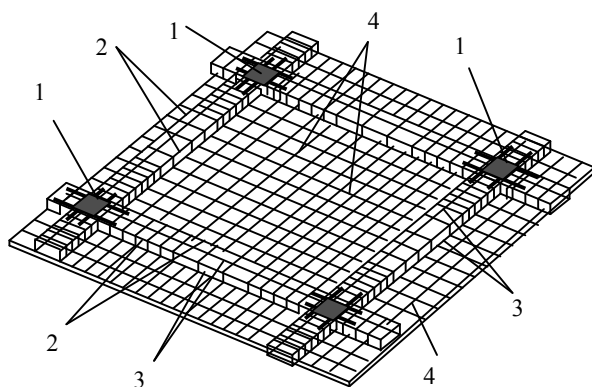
Схема безбалочного бескапитального перекрытия с ригельным армированием плиты
